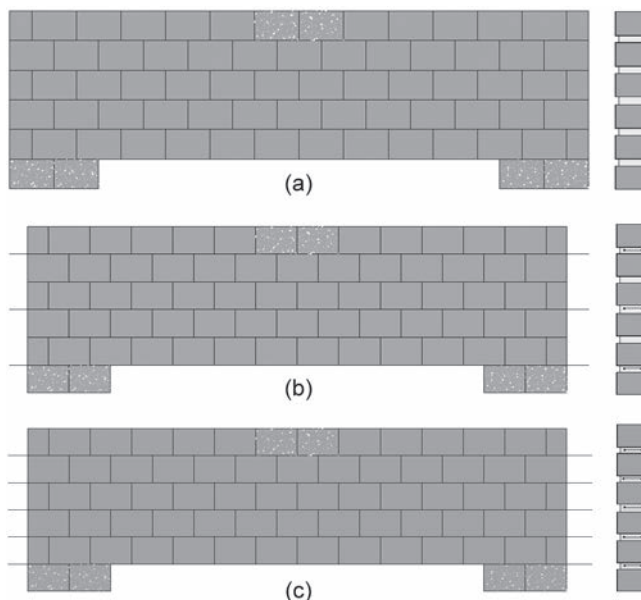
Modelos das mini paredes ensaiadas: (a) Série 1 – sem armadura, (b) Série 2 – armadura imersa na argamassa a cada duas juntas horizontais, (c) Série 3 – armadura em todas as juntas horizontais.
